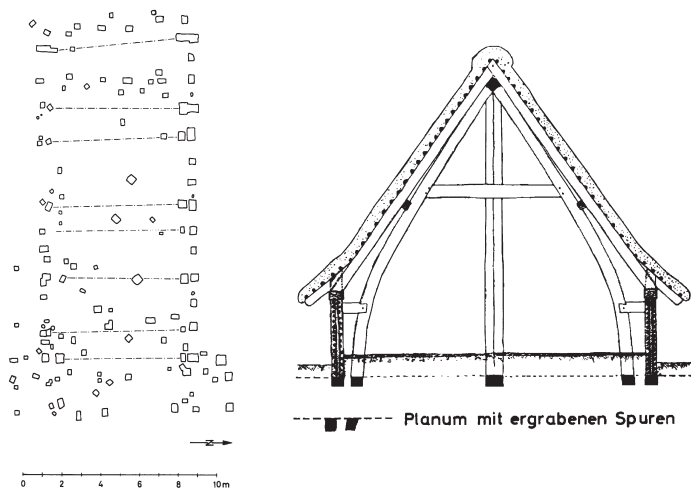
Links: Grundriss aus Kamen-Westick. Rechts: Rekonstruktion nach KLEIN 1936 (beide nach TRIER 1969, Taf. 26b).
